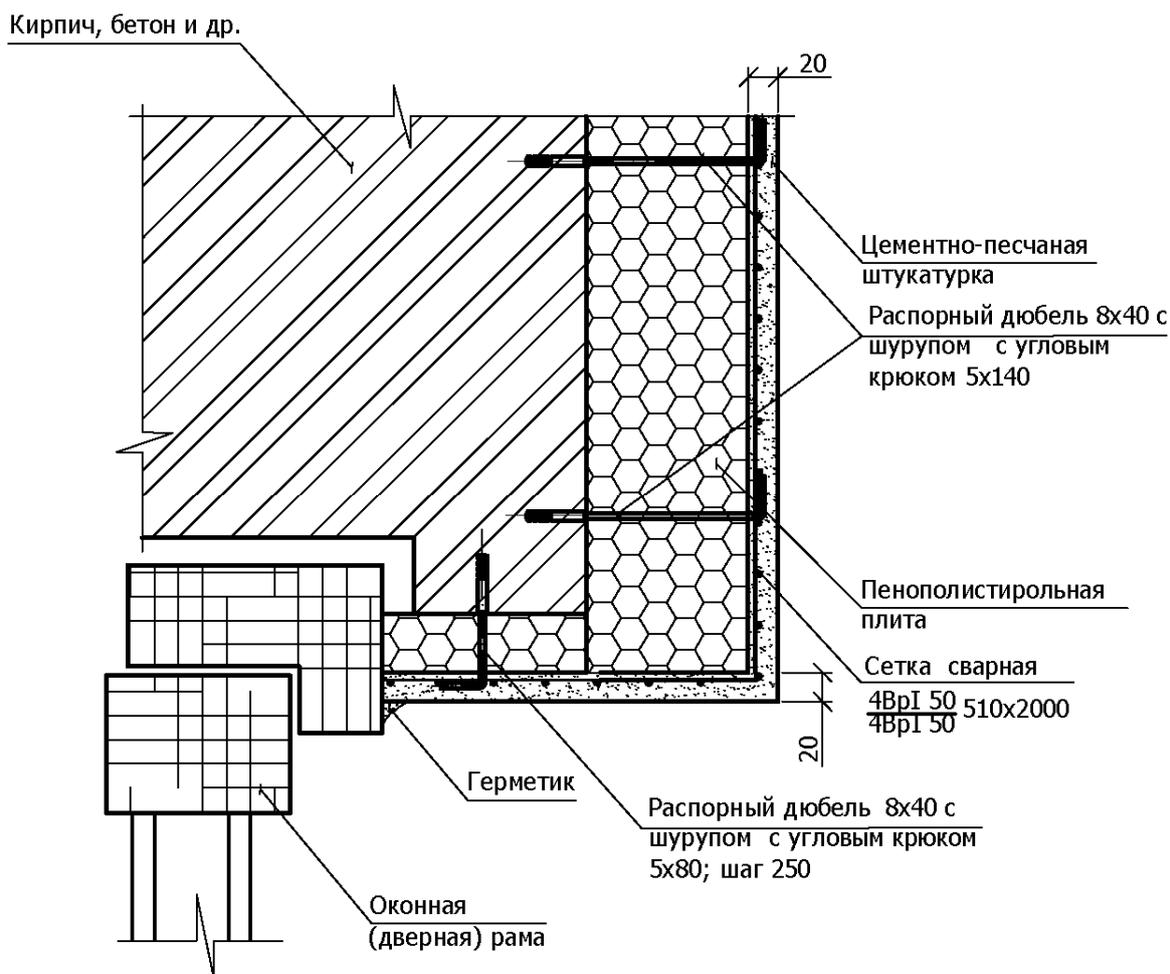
Утепление остекленных лоджий, балконов и воздушных переходов незадымляемых лестничных клеток. Утеплитель – пенополистирольная плита. Примыкание системы к оконной (дверной) раме (вариант 3)
